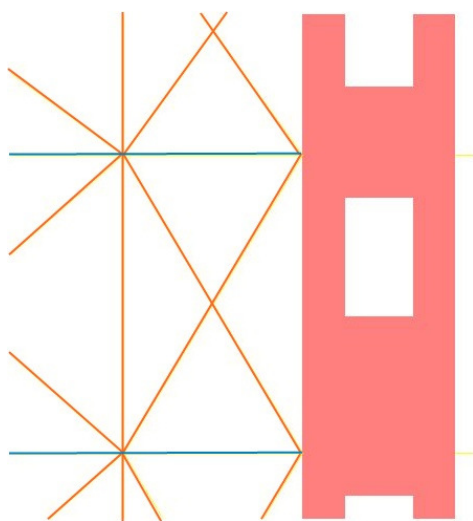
Modelação de tabiques (a cor de laranja), e vigas rígidas (a azul)
